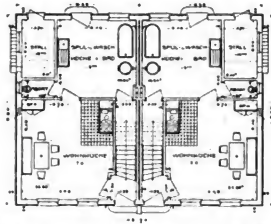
Grundriß zu Abb. 117. Erdgeschoss.
